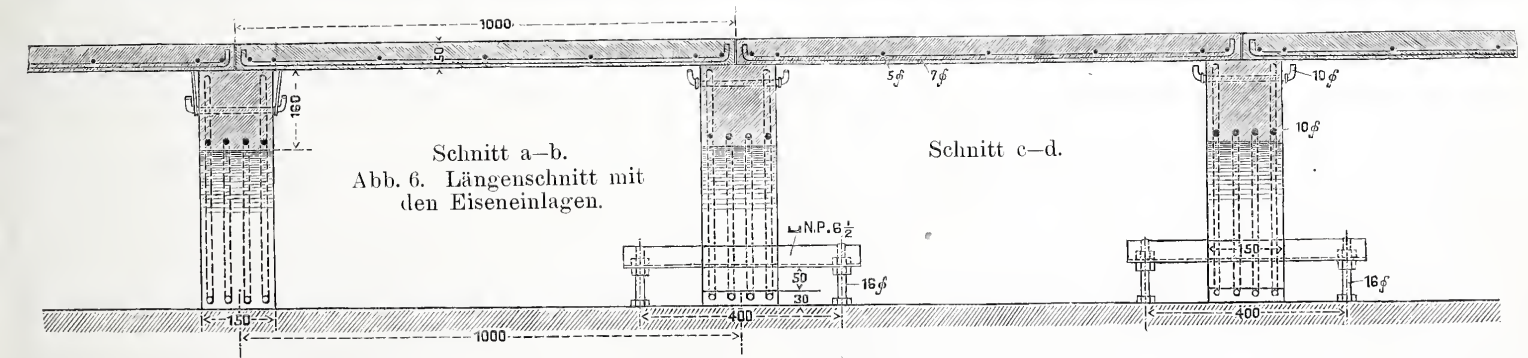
Längenschnitt mit den Eiseneinlagen.
